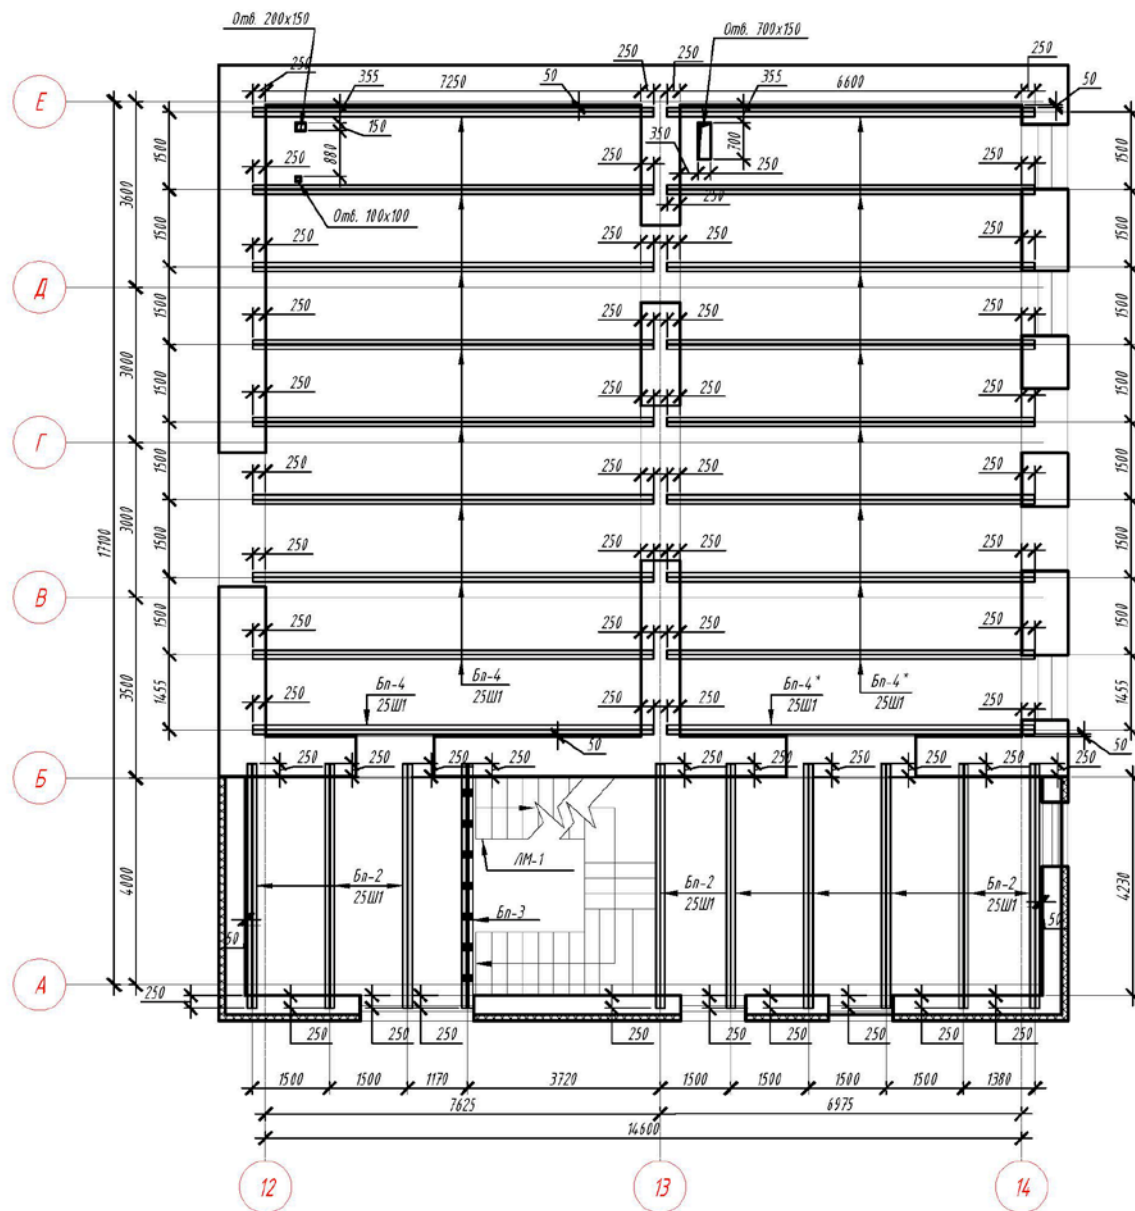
Схема перекрытия на отметке +3,000 +6,000
